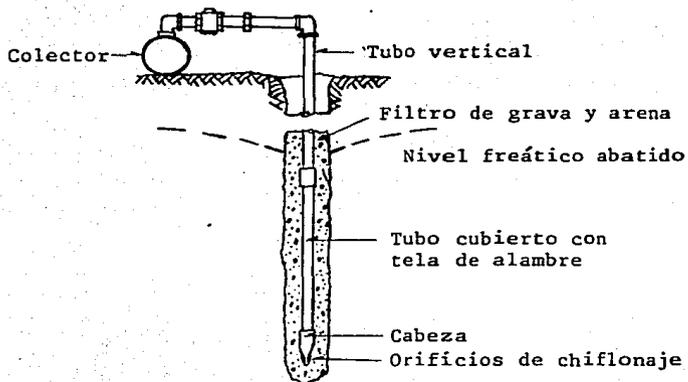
DETALLE DE UN POZO PUNTA.
